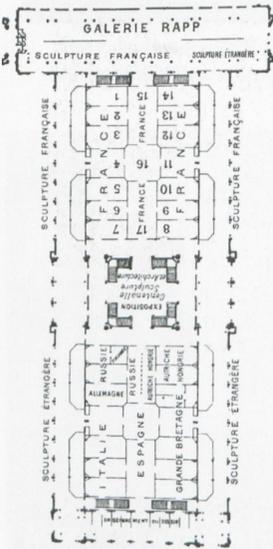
Palais des Beaux-Arts, Ausstellungsplan des Erdgeschosses
